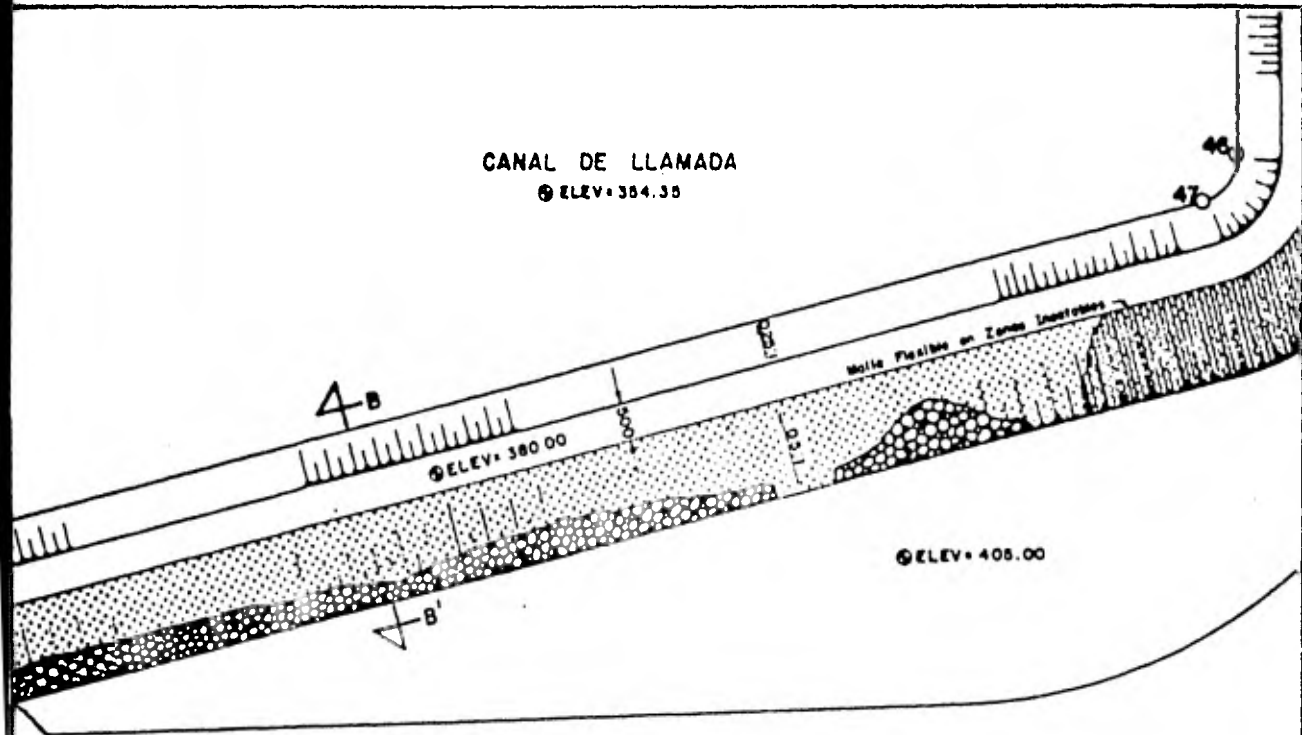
TRATAMIENTO DE LA ROCA EN TALUD ZONA DE ESTRUCTURAS
